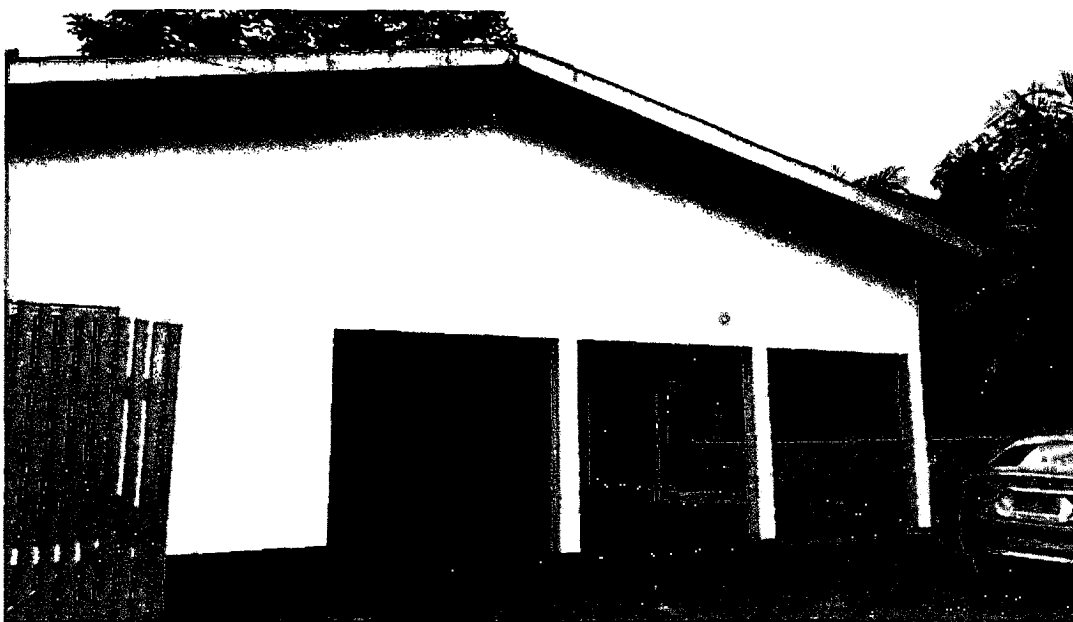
Foto fachada Casa de Apoio da Associação Solar das Acácias - 11/03/2017
